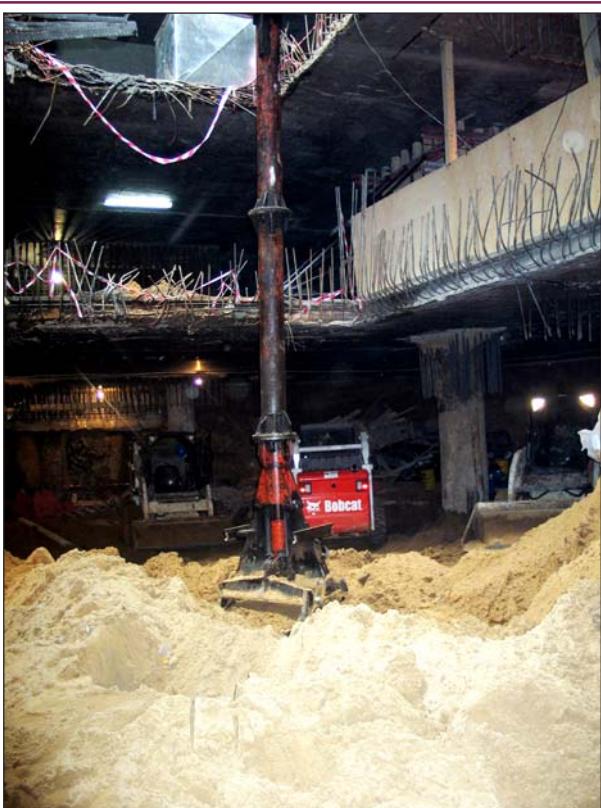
Возвведение монолитного железобетонного перекрытия над четвертым подземным этажом в зоне вывешенной на буровых колоннах рампы.
